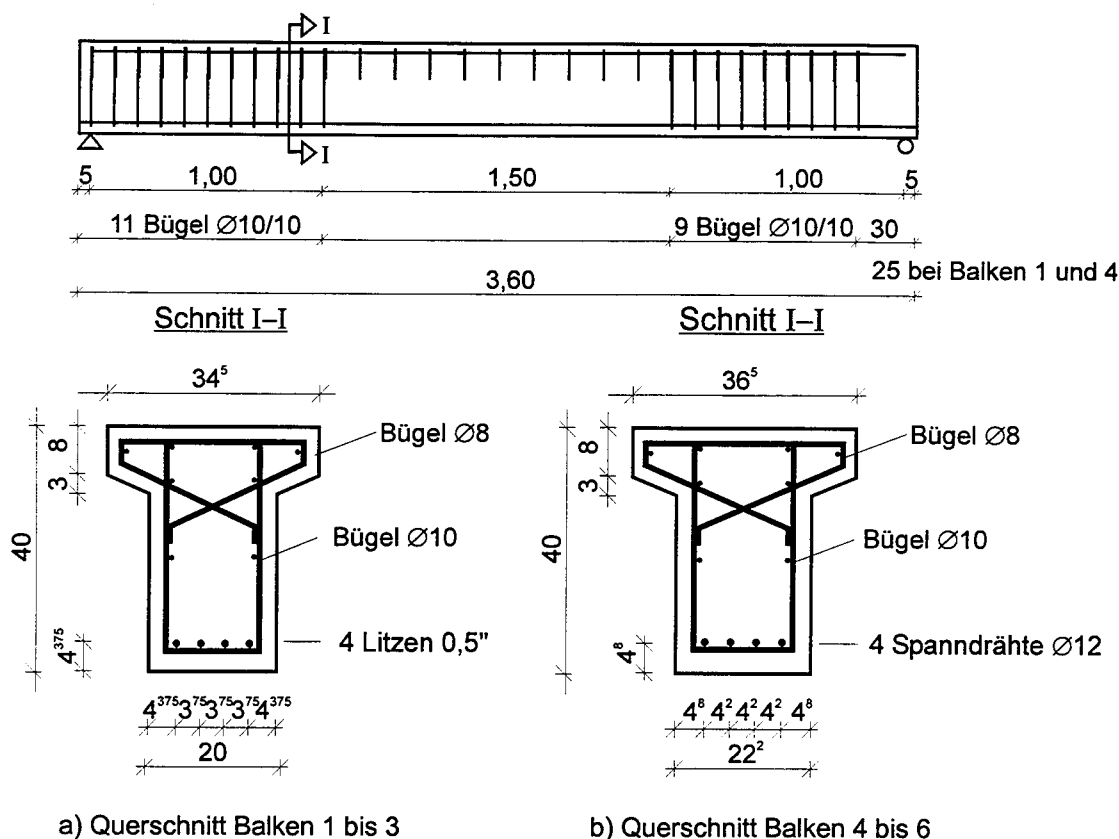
Abmessungen und Bewehrung der Balken mit vier Spannstählen
